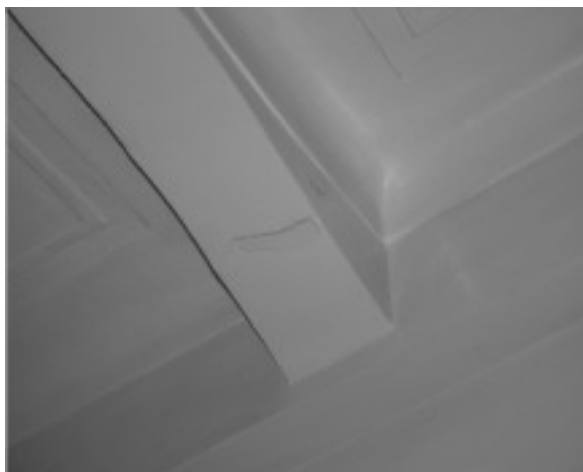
Трещина приопорного участка балки перекрытия 2-го этажа центральной части здания
